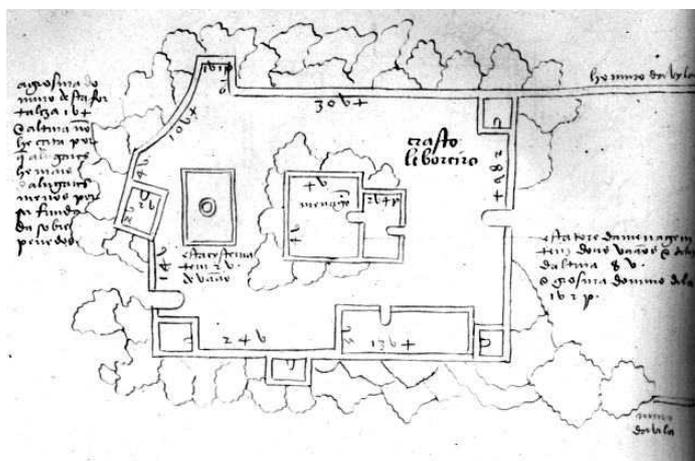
Planta do século XVI do Castelo de Castro Laboreiro (Armas, 2006)
